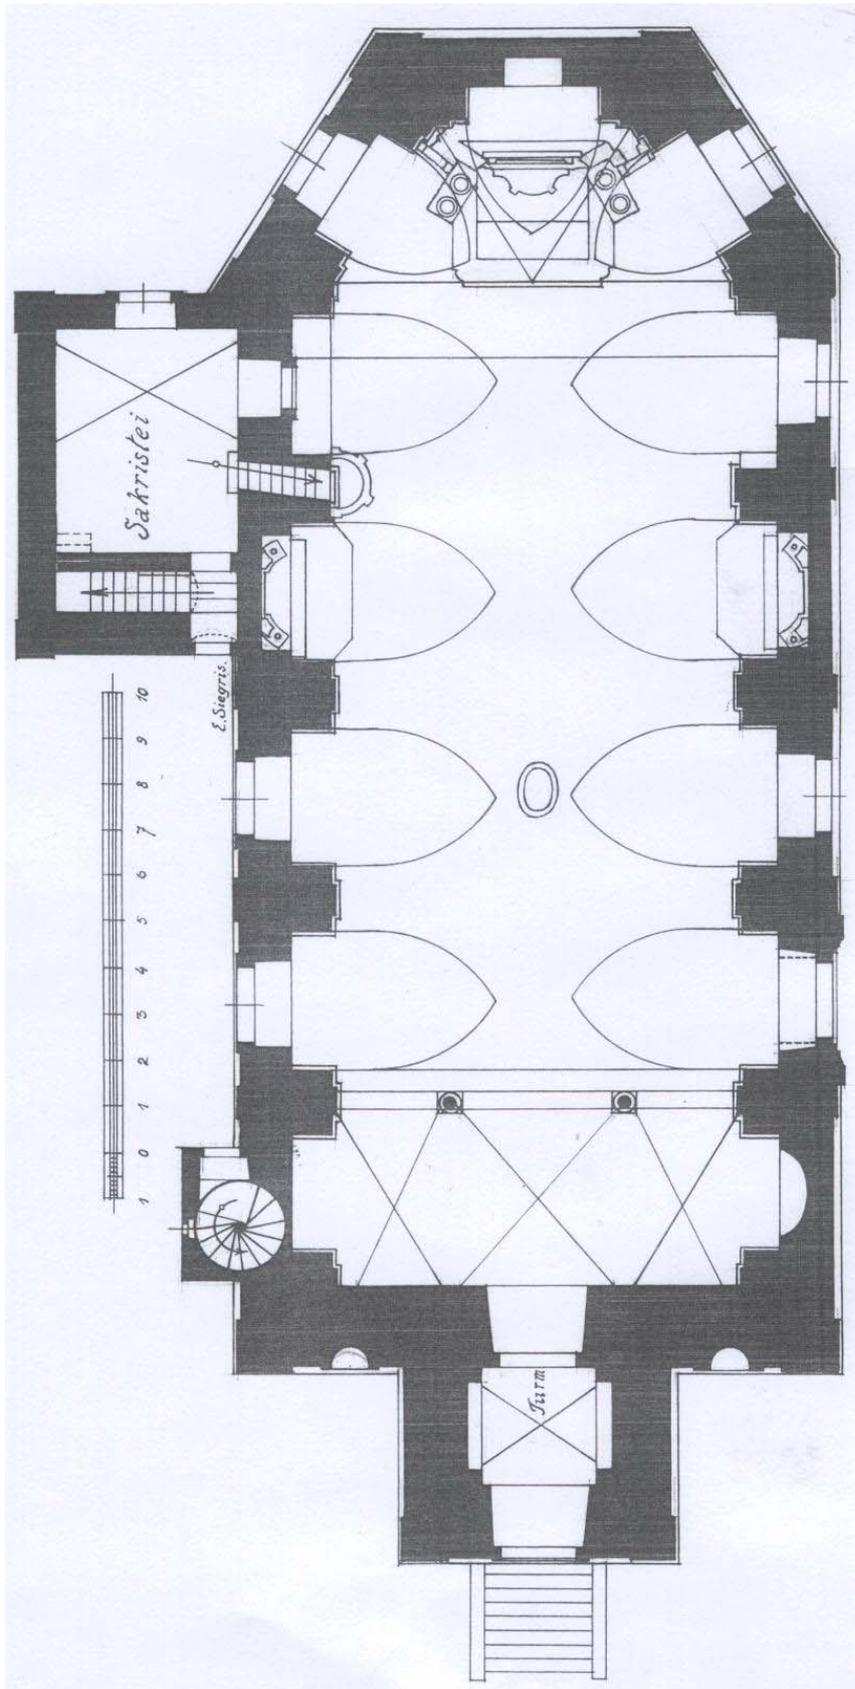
, Grundriss 1, Donnerskirchen, Pfarrkirche³²¹
